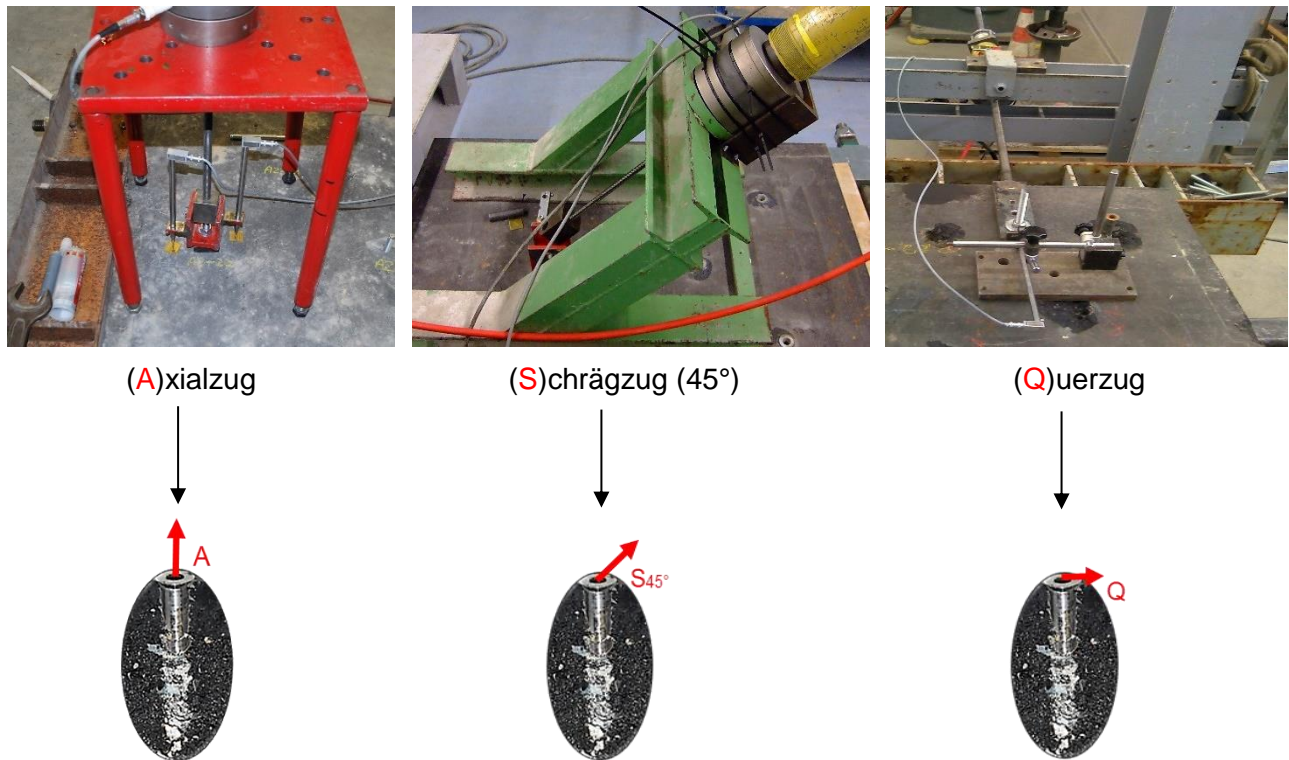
Versuchsaufbau; Oben: Links Axialzug mit weiter Abstützung; Mitte Schrägzug; Rechts Querrug; Unten: Symbol für Zugbelastung in Axial-, Schräg-, und Querrichtung
